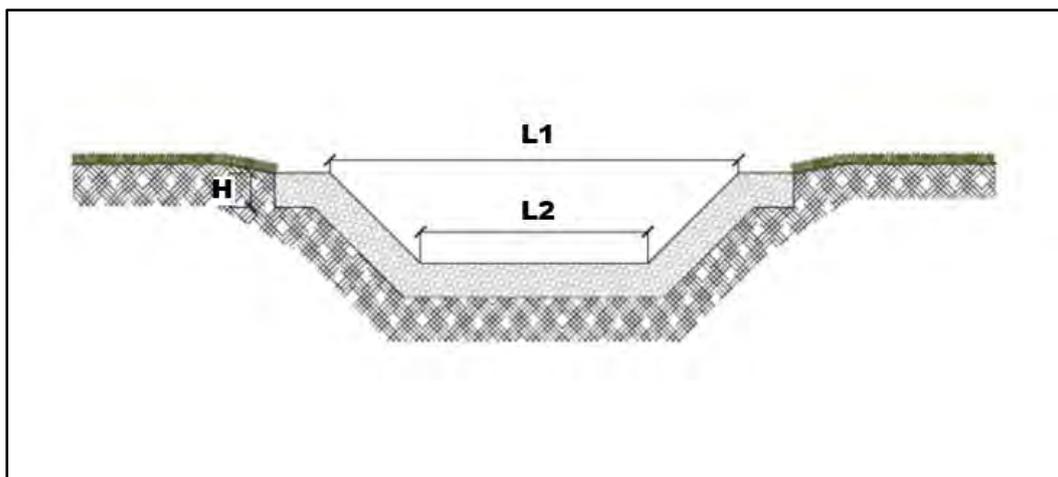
Sezione tipo del canale trapezoidale rivestito in materassi Reno
